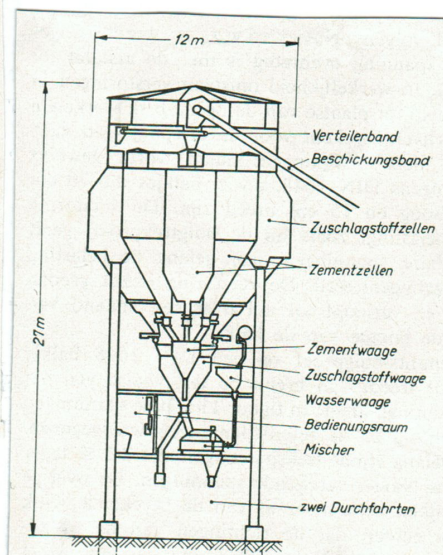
Schema van de betonmortelbereidingsinstallatie.
